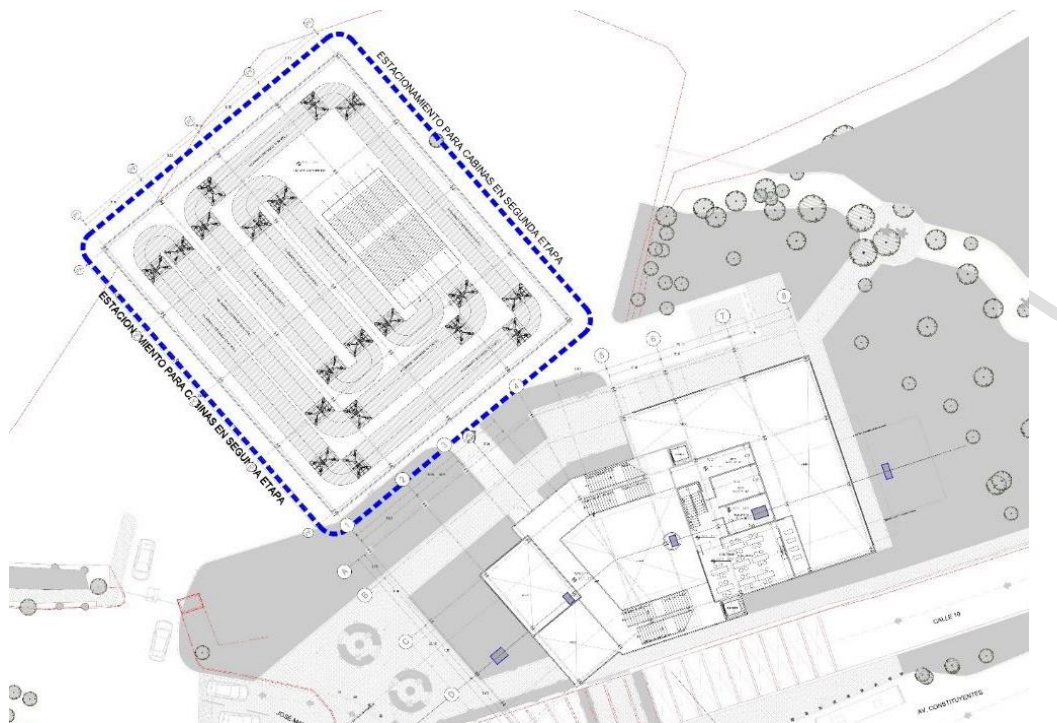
Planta Mezzanine con estacionamiento de cabinas a construirse en una segunda etapa Estación CAM SAM / CRI CRI
